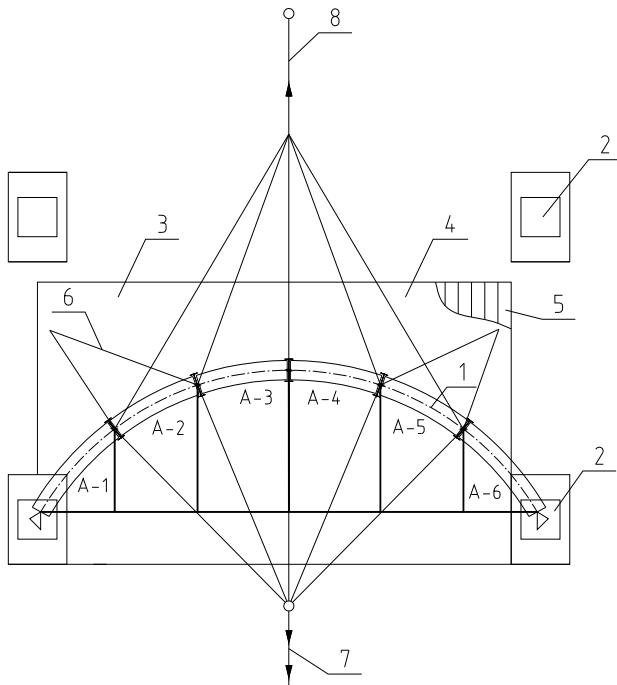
Схема монтажа арок на сплошных подмостях:
